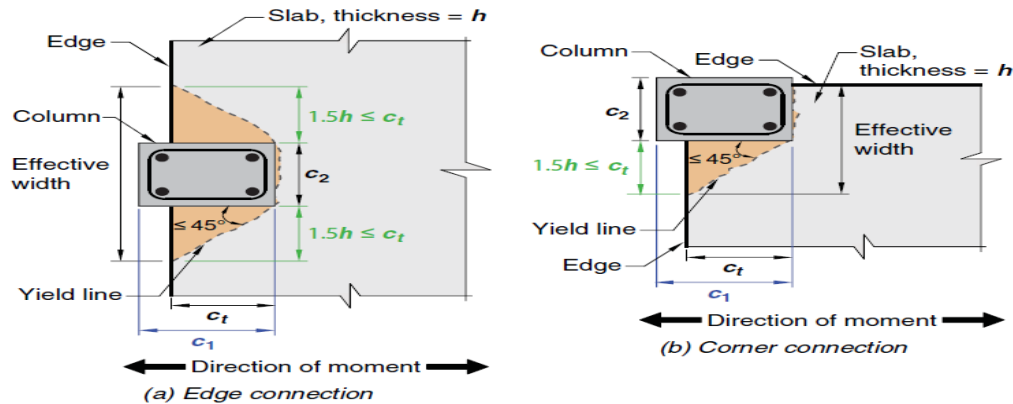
Ancho efectivo en conexiones. (American Concrete Institute, 2019)
